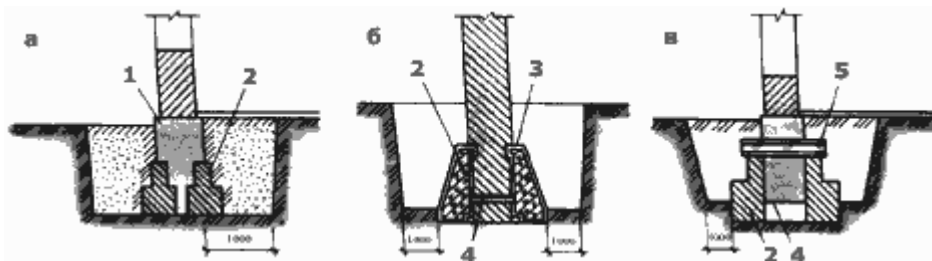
Усиление фундаментов путем усиления подошвы: а - уширение бутовой кладки; б - уширение из железобетона; в - крепление банкета к фундаменту поперечными балками; 1 - существующая кладка; 2 - уширение фундамента; 3 - опорная полка; 4 - анкер; 5 - поперечная металлическая или железобетонная балка.
